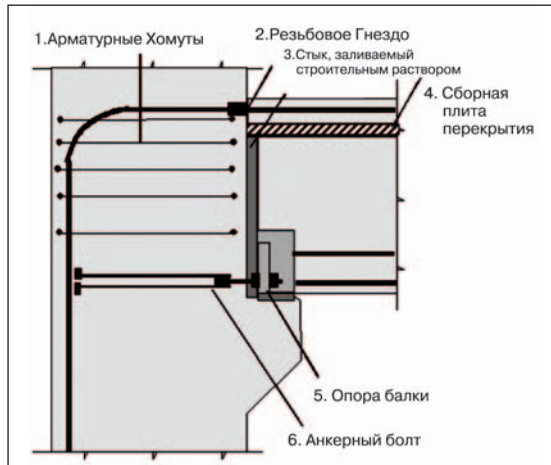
Наружные узлы балка-колонна в сборном изделии.
